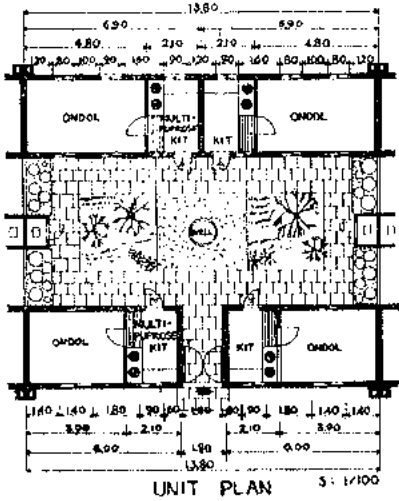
R.H.A-I형(5, 45.5, 56평) Unit Plan S:1/100
